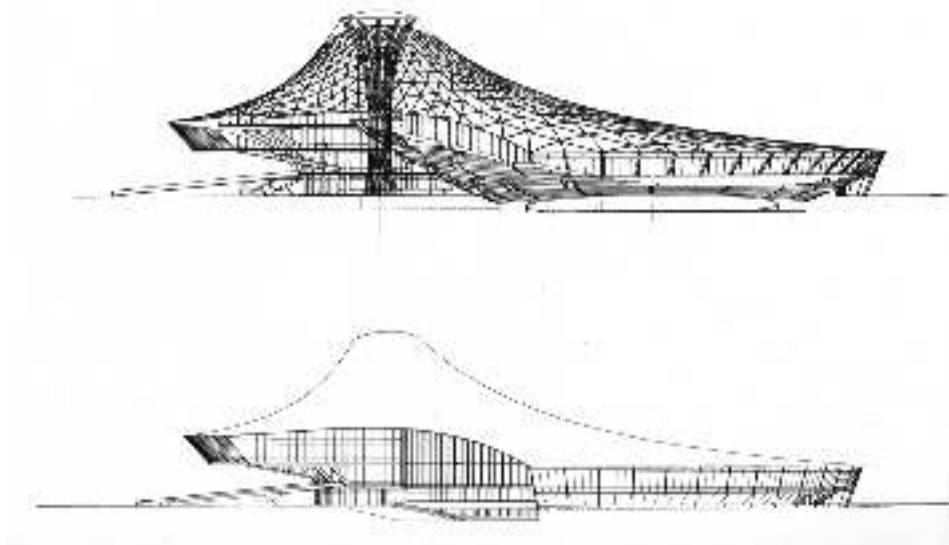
Progetto per il Palazzetto dello Sport di Firenze, 1965, sezione e prospetto.
